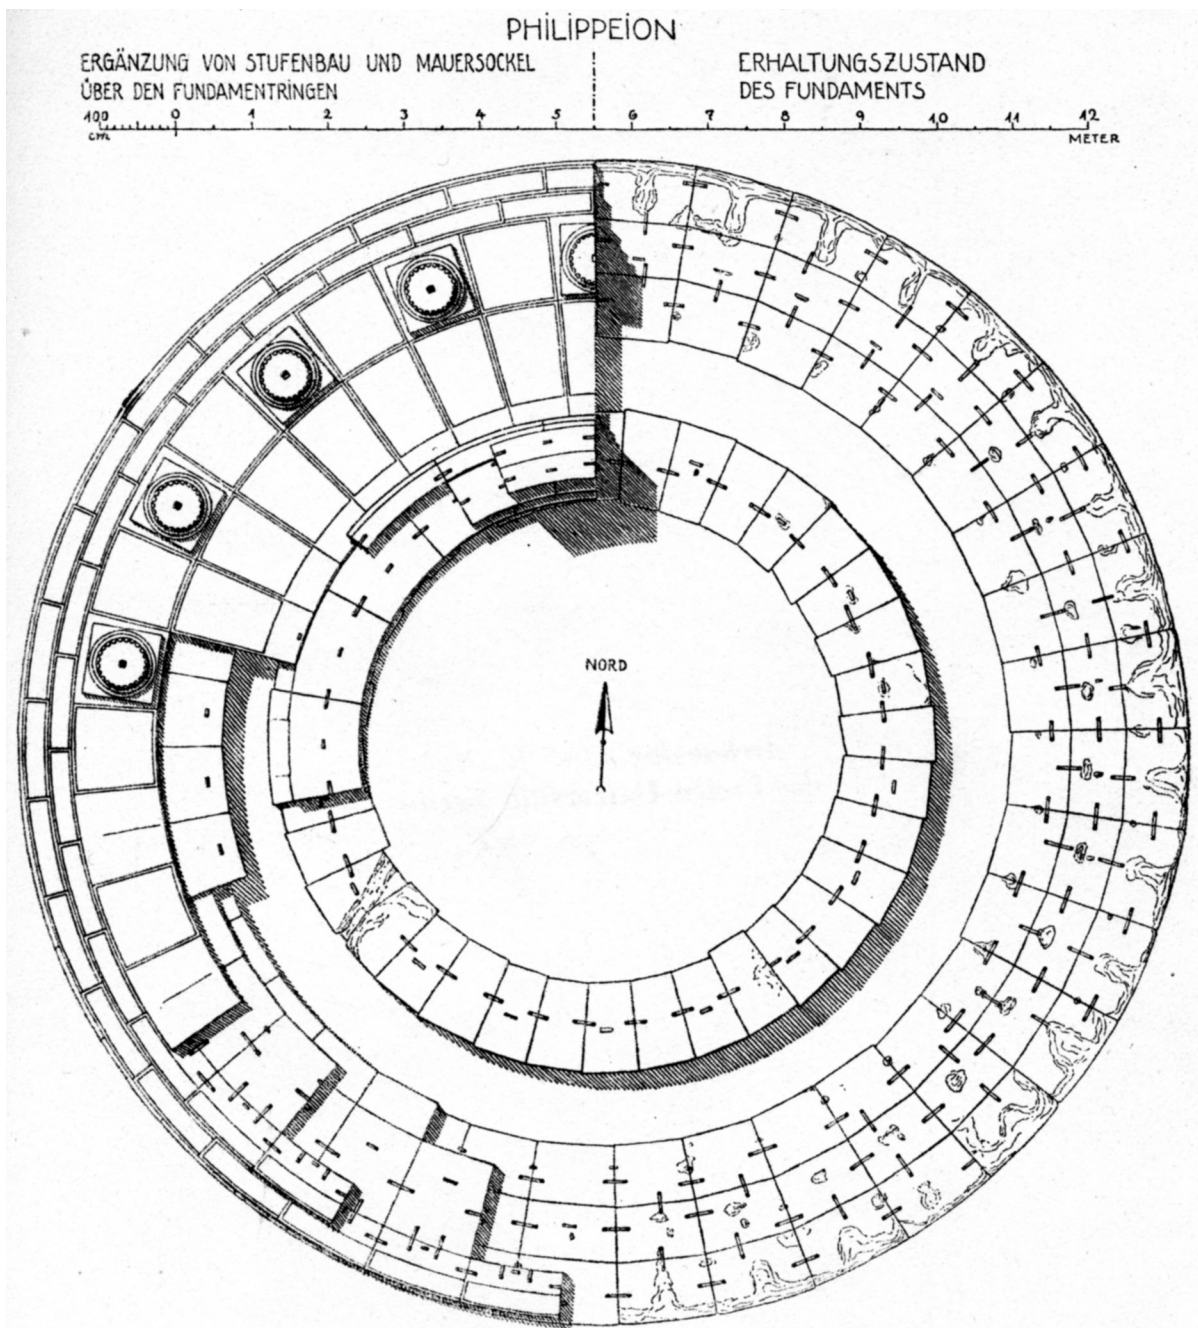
Grundriss und Rekonstruktion des Philippeions (M. 1 : 100)
